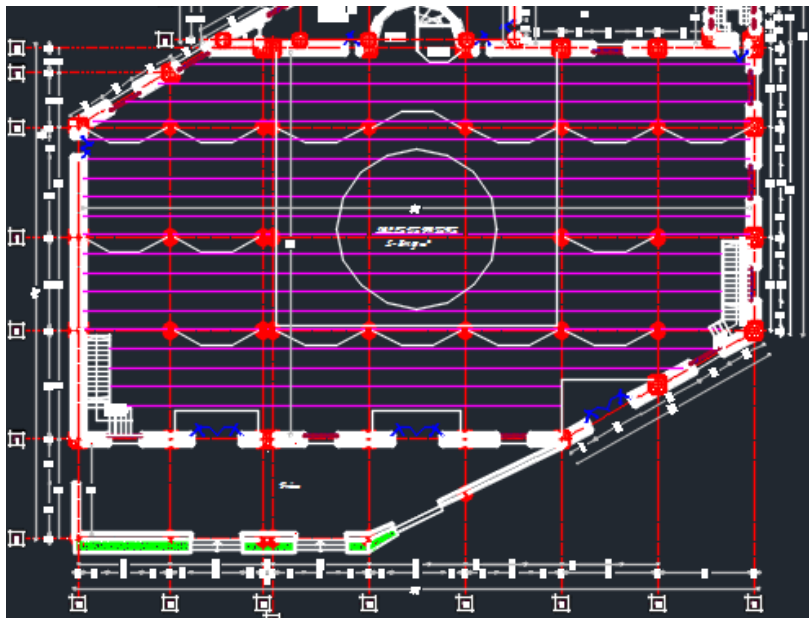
Vue en plan salle de prière homme (deux joints).
